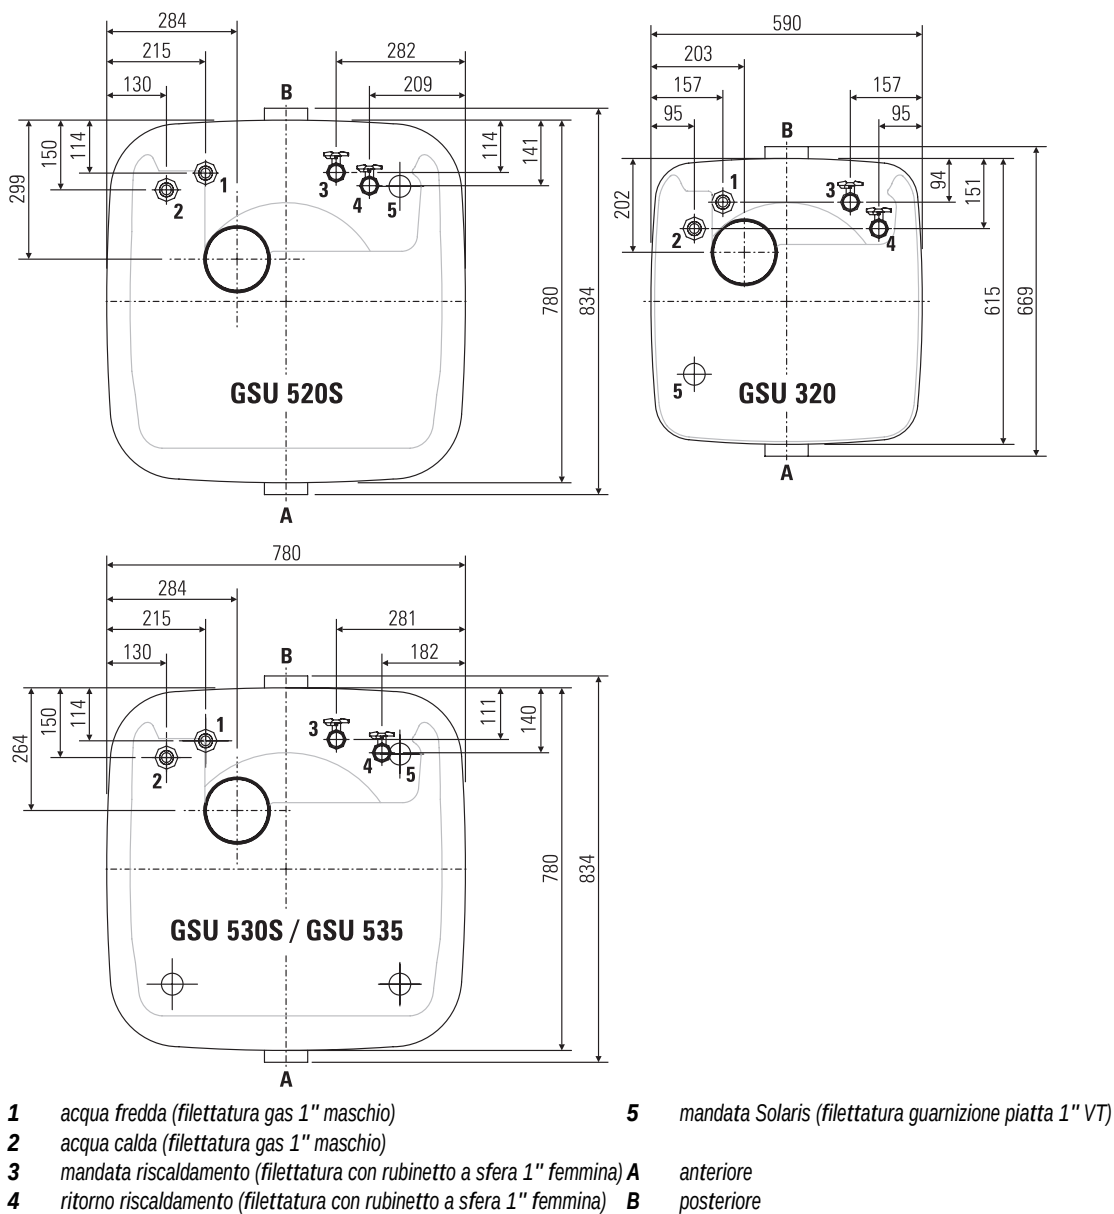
Collegamenti per allacciamenti idraulici e di riscaldamento (vista dall'alto) (vedere capitolo 3.6)
